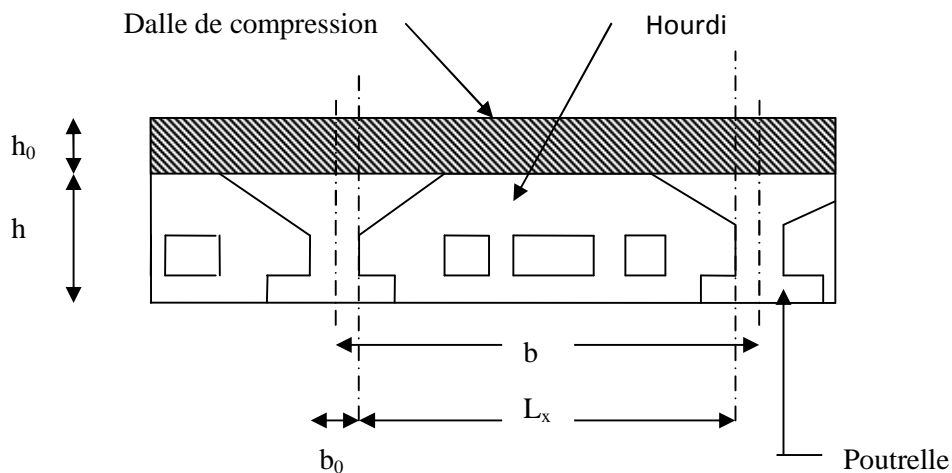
Coupe transversale sur un plancher à corps creux
